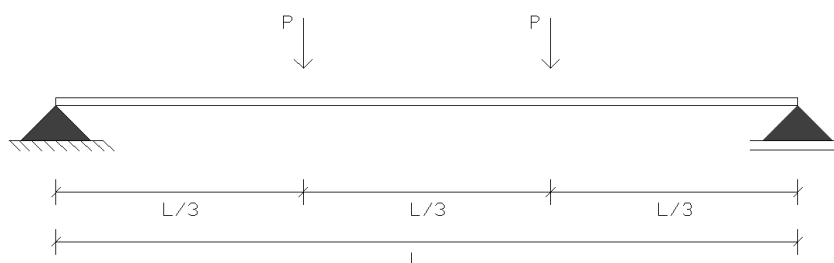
Esquema de ensaio de flexão simples – Ensaio 1, Ensaio 4 e Ensaio 7.
